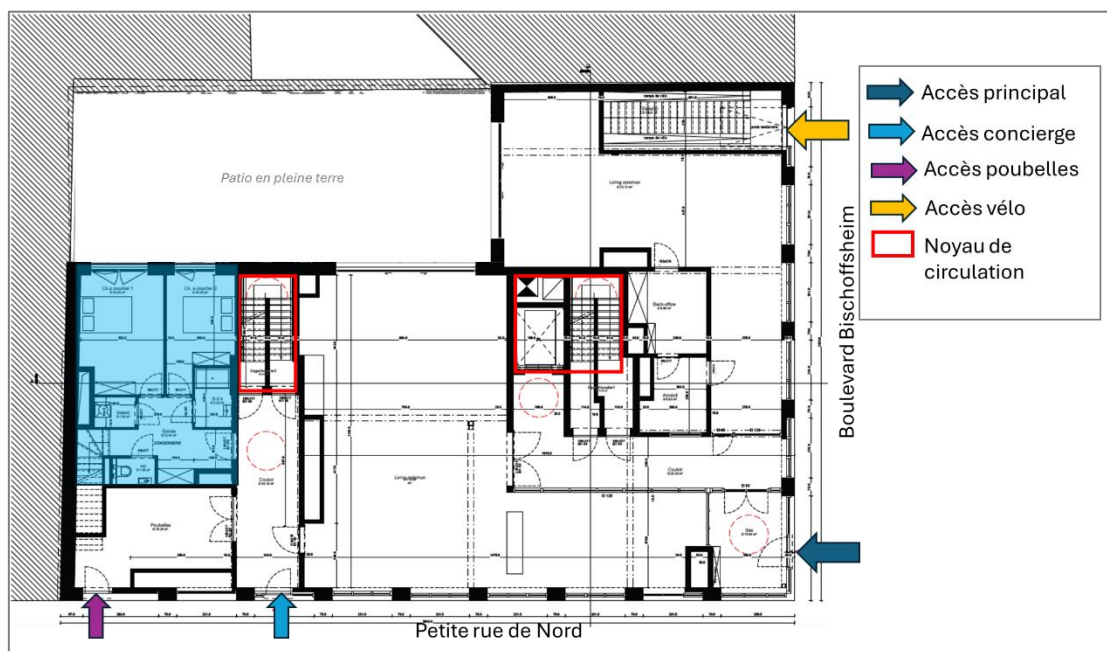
Accès au projet (source du fond de plan : B2Ai)
